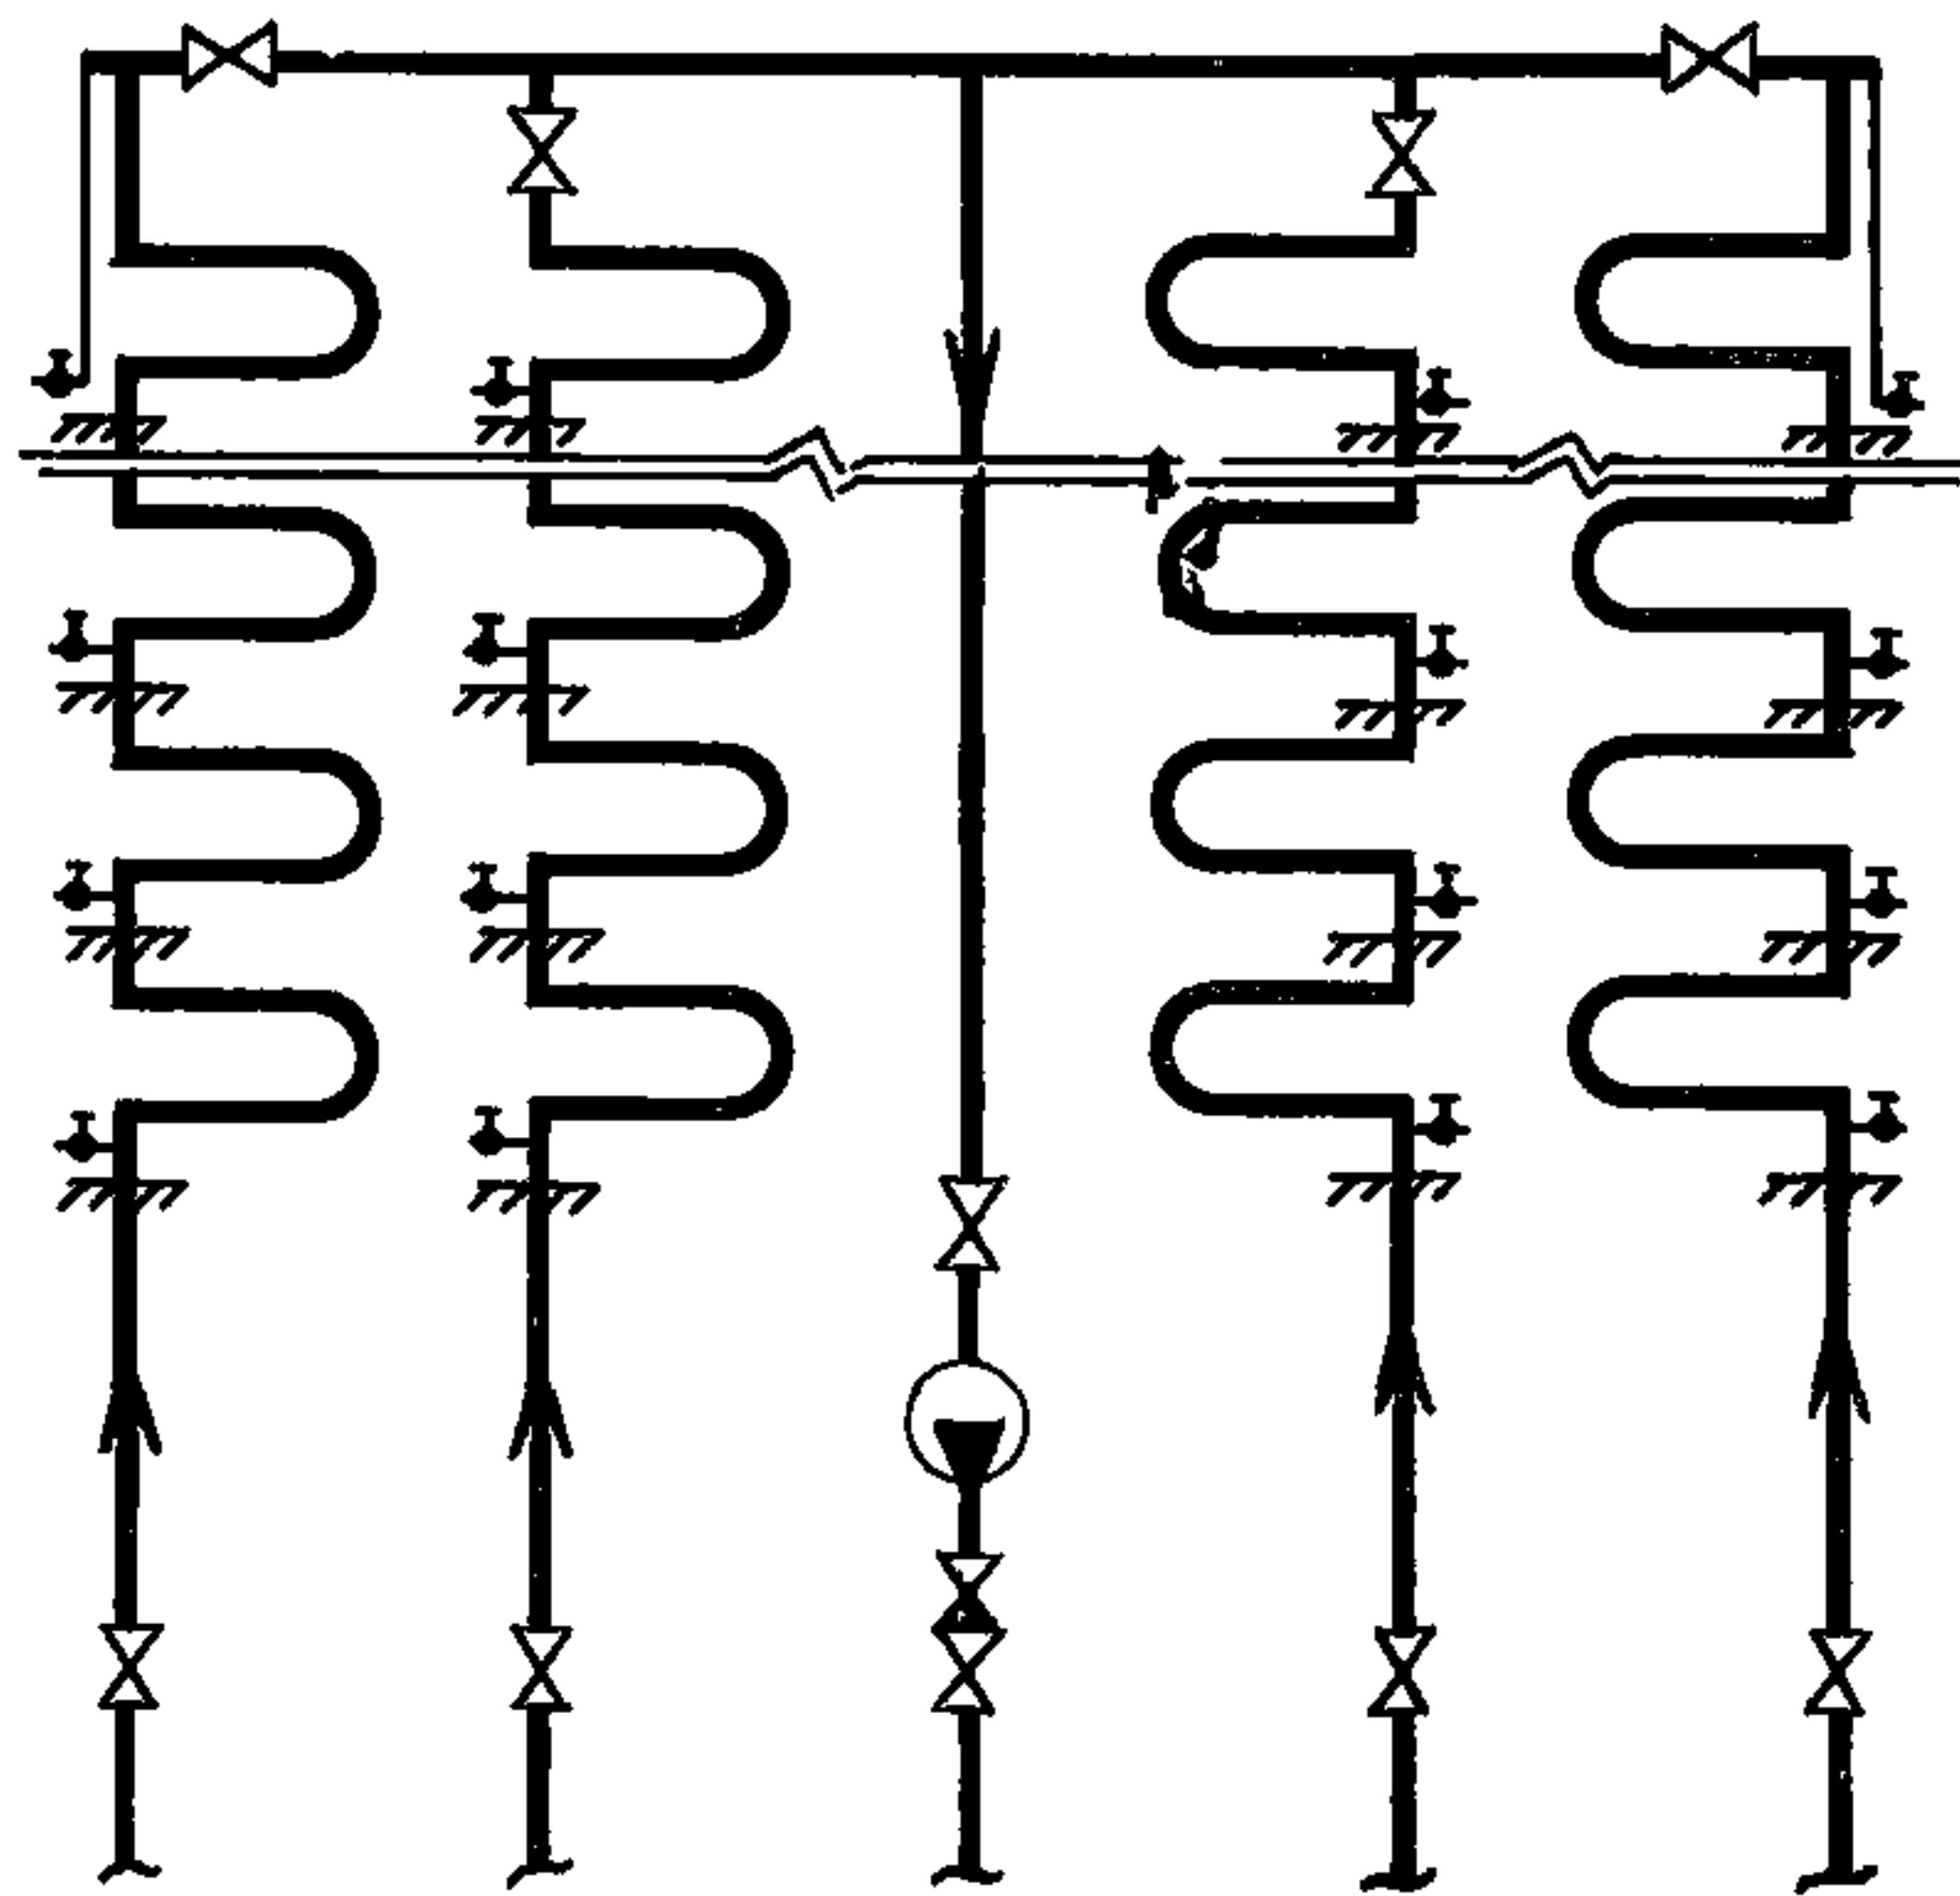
Принципиальная схема системы горячего водоснабжения с циркуляционным стояком и насосом ЦВЦ
